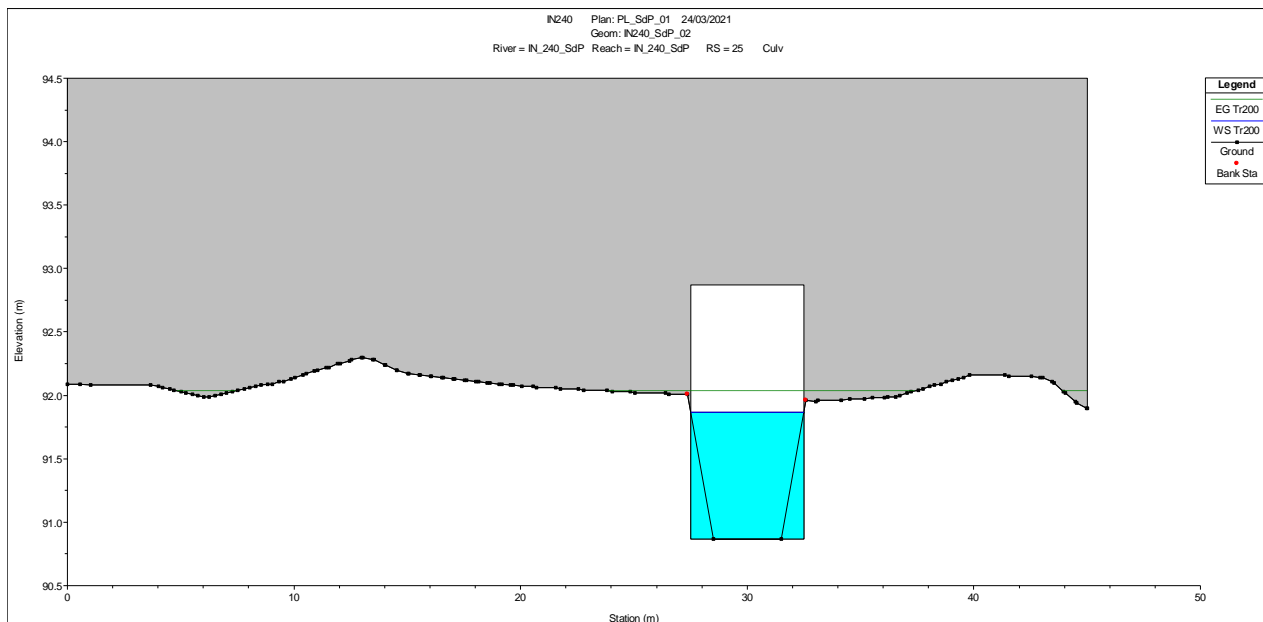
Sezione monte manufatto – stato di progetto attraversamento stradale interferenza IN240.
